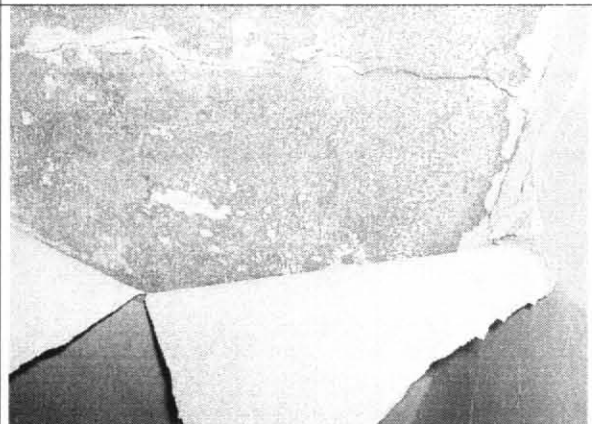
Fisuras superficiales en la placa de cubierta y desprendimiento de acabados.
